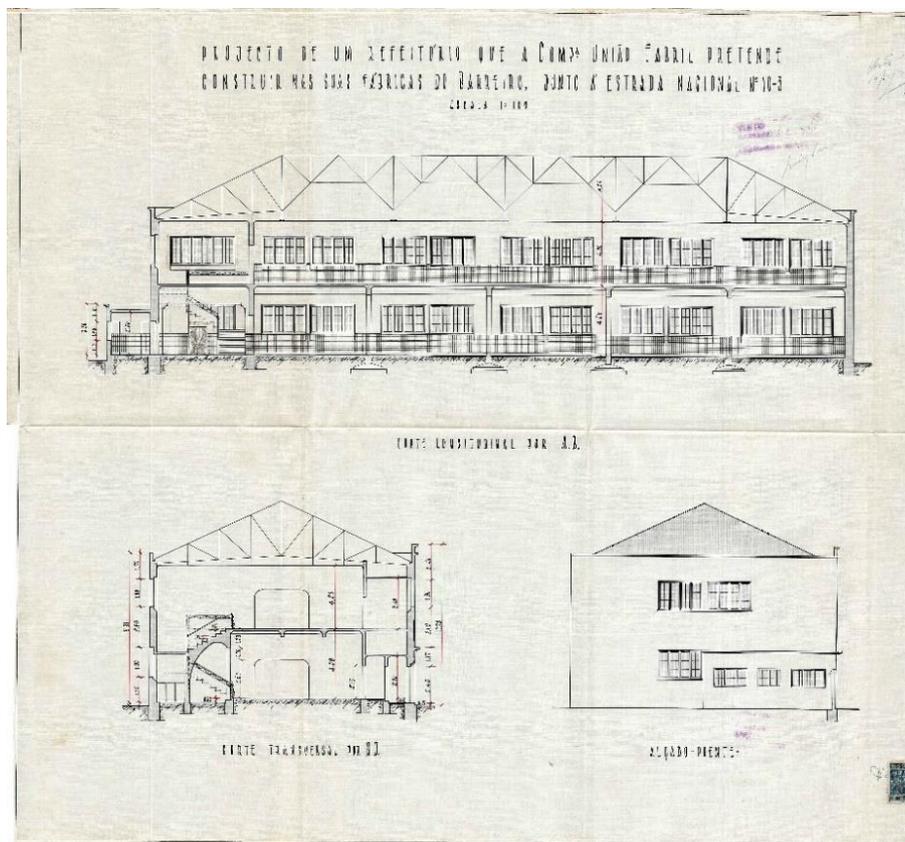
Conjunto de Cortes e Alçado do Refeitório que a CUF construiu nas suas fábricas do Barreiro
